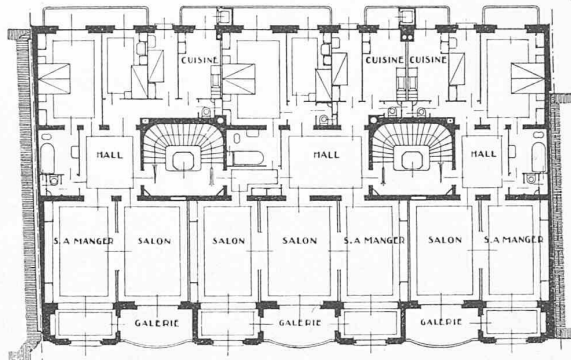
Grundriss eines Obergeschosses des Miethauses „Splendid Rivage“ in Genf. — Masstab 1 : 400.
